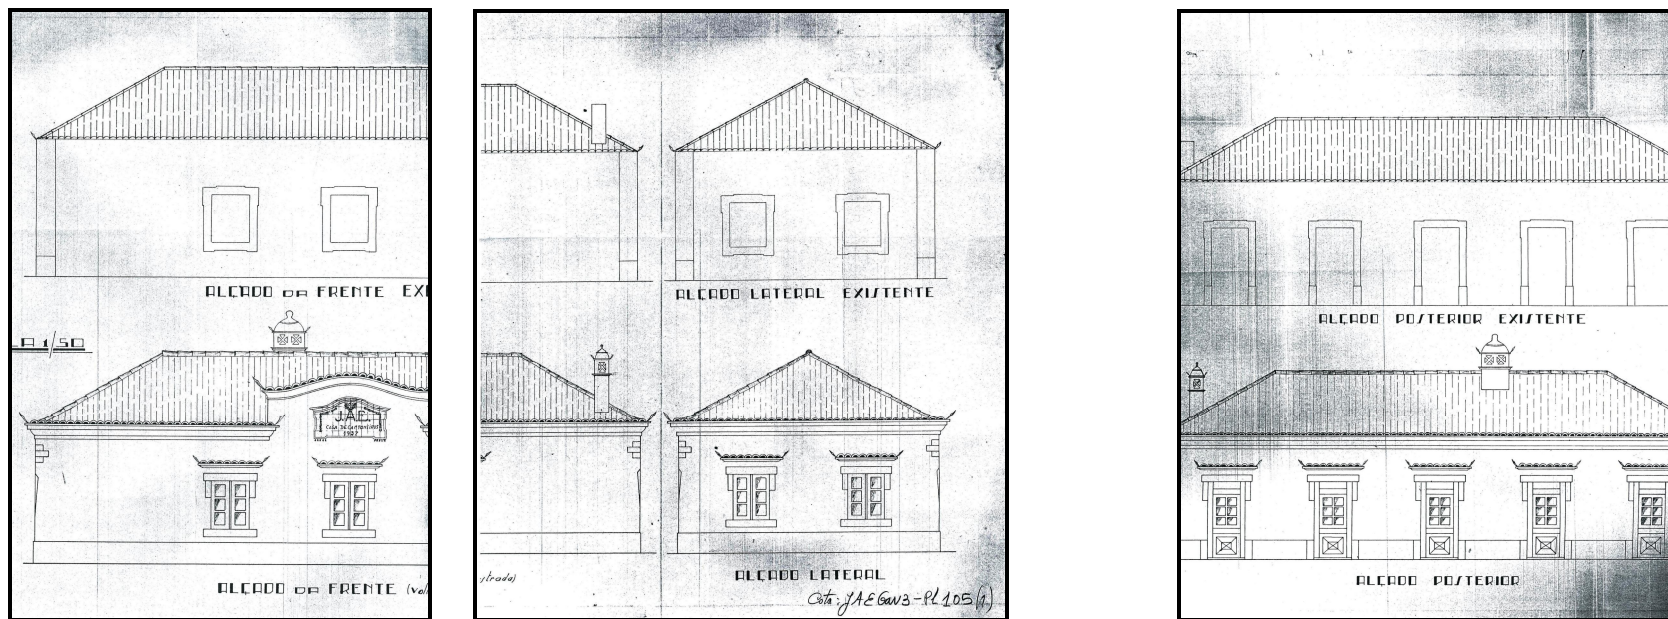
Casa de cantoneiros do Falacho: projecto de alterações.
